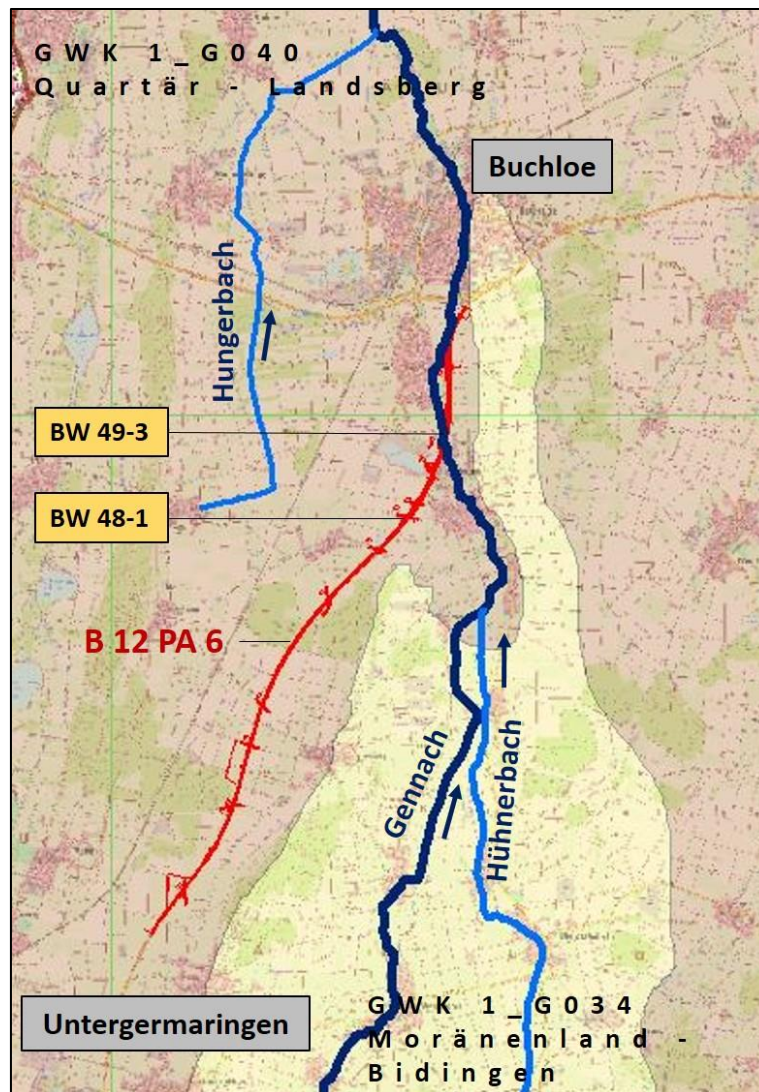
Geplanter Ausbau B 12 (PA 6) Untergermaringen – Buchloe: Übersicht mit Wasserkörpern und betrachtungsrelevanten Bauwerken
